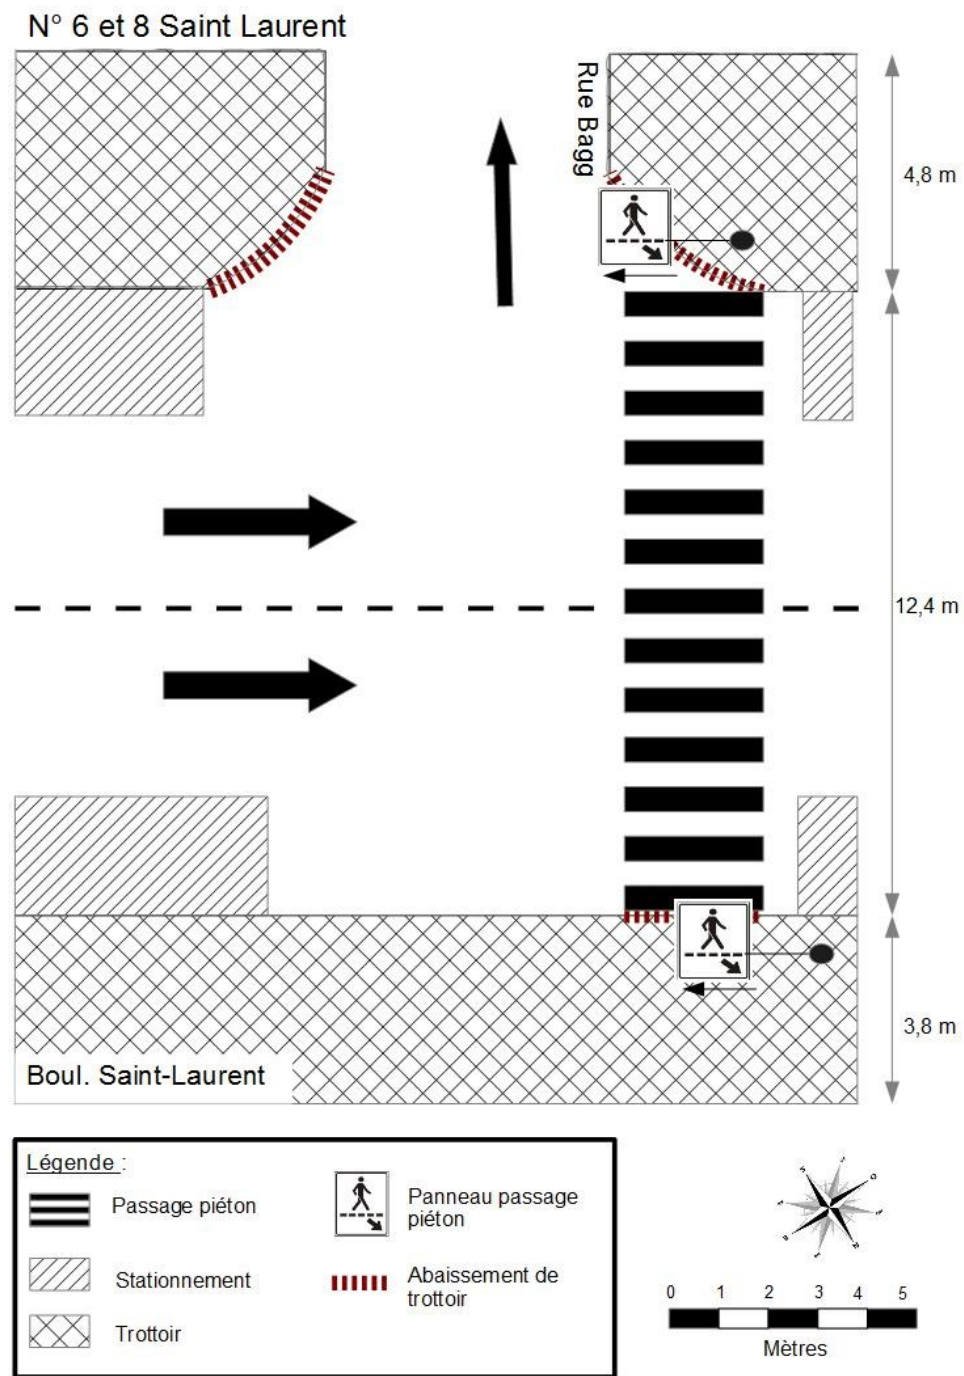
Site # 6 et # 8 boulevard Saint Laurent
